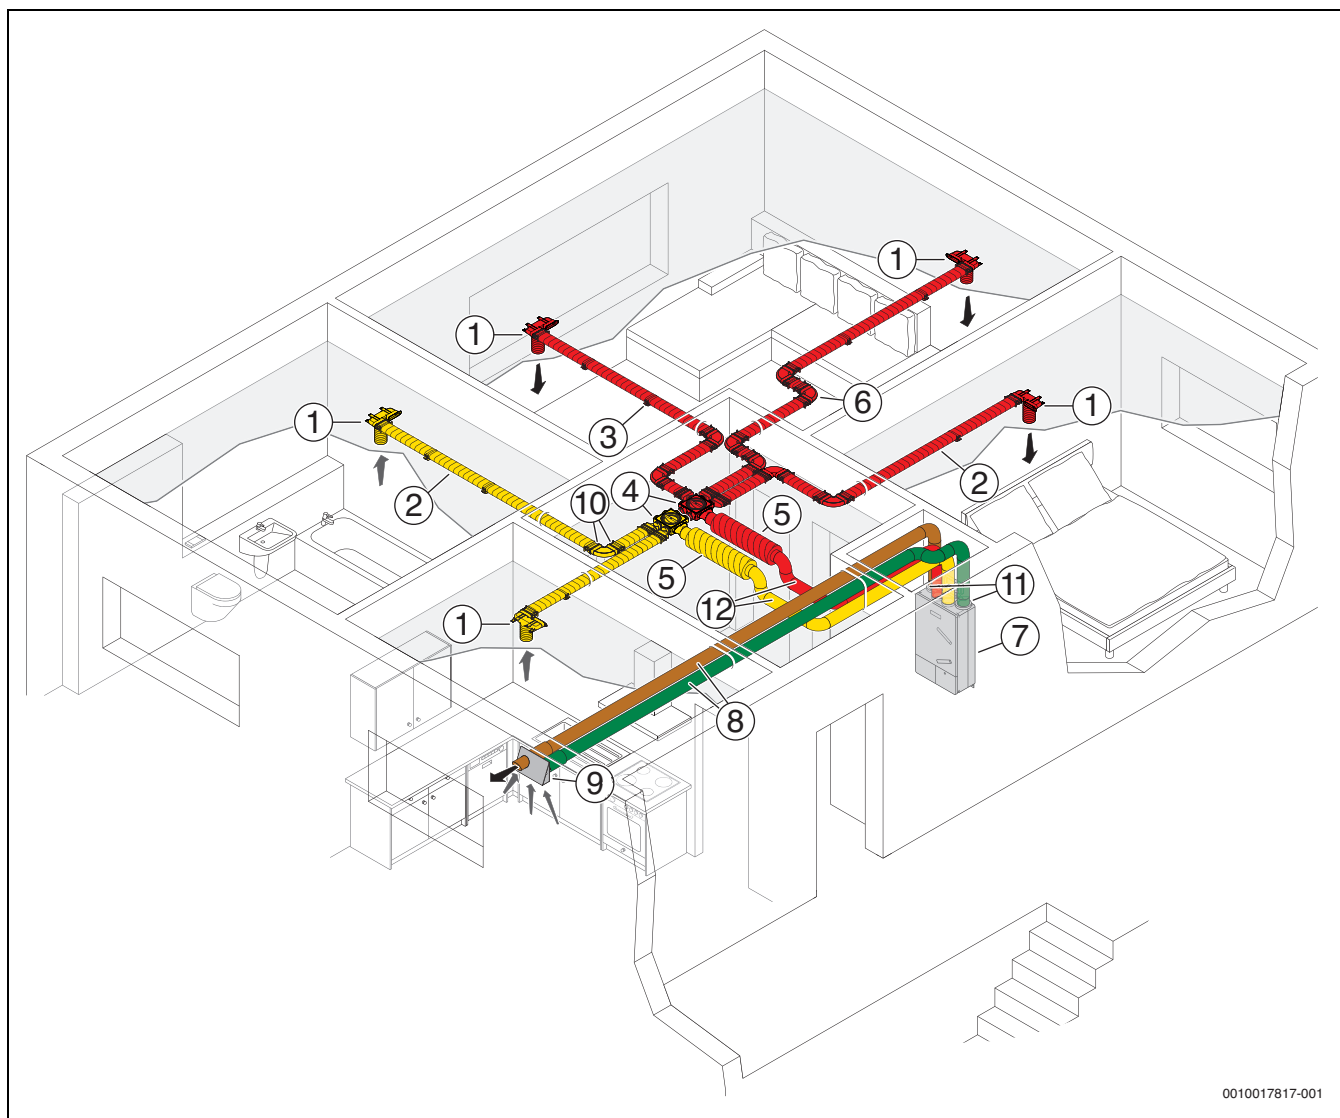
Esempio di impianto con accessori abbinabili - installazione a parete (solo HRV156-100 K)
